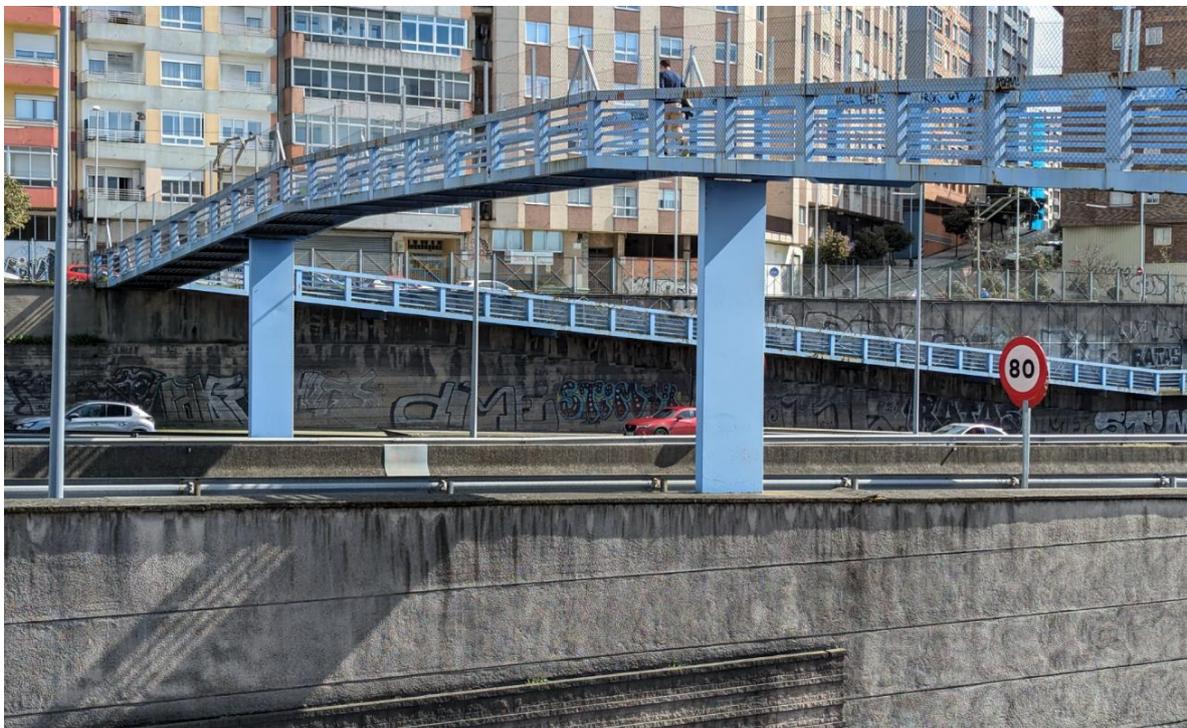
Vista de vanos 5, 6 y 7, pilas 4 y 5 y rampa sobre vigas empotradas en muro
